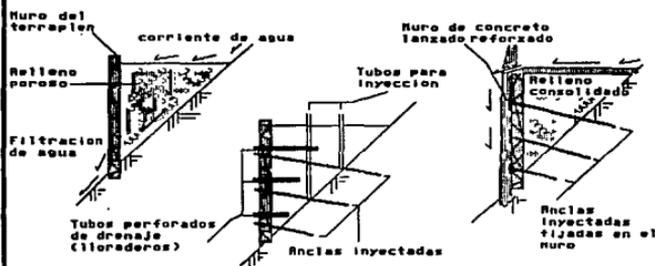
REPARACION DE UN TERRAPLEN CON CONCRETO LANZADO Y MORTERO INYECTADO EN PELIGRO DE FALLA
